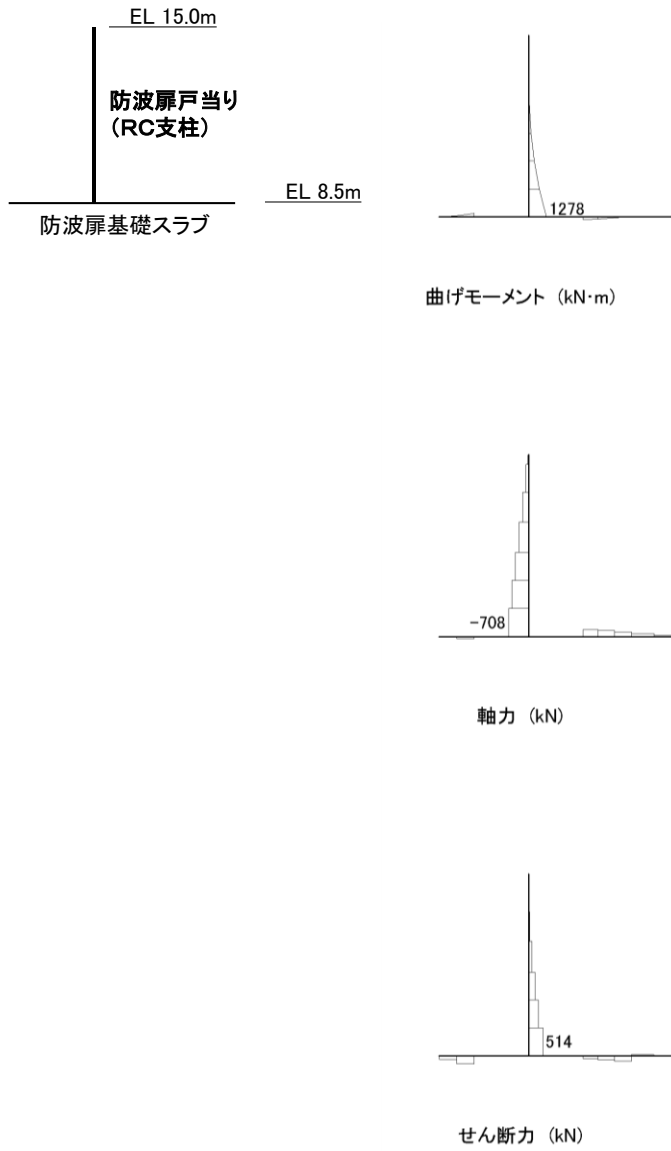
コンクリート及び鉄筋の曲げ・軸力系の破壊に対する照査断面力図
